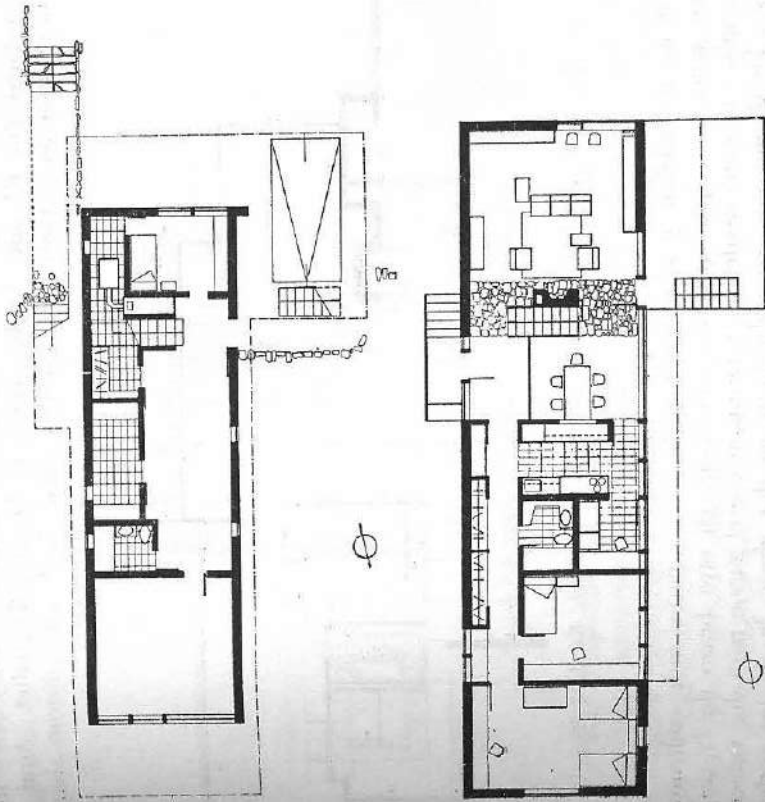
Marcel Breuer: Casa en New Canaan, Conn. Planta baja y planta alta. Escala 1:250.
